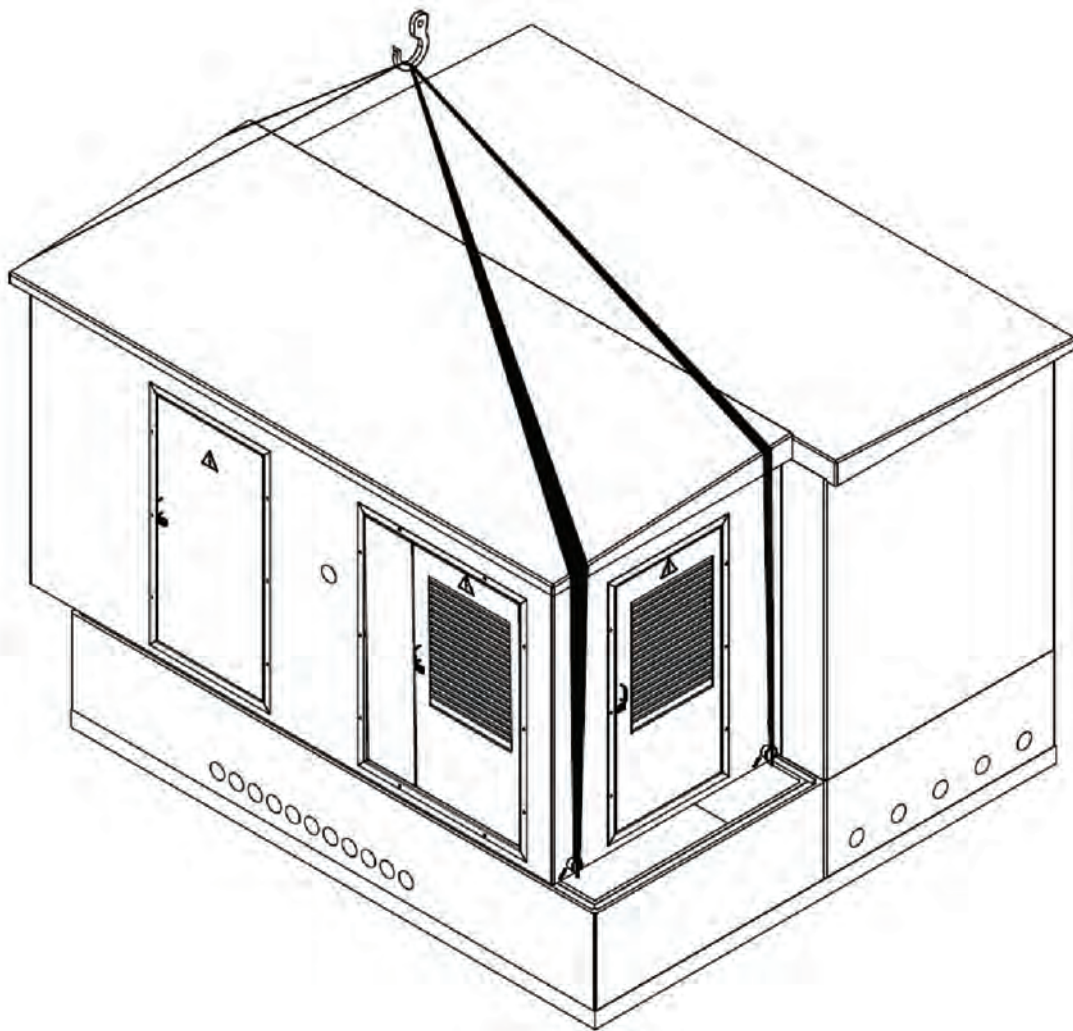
Установка корпусов с крышами на кабельные подвалы
